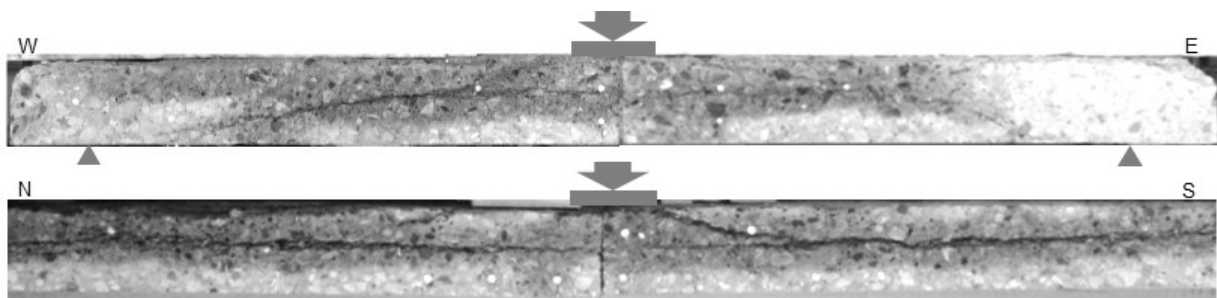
供試体 CF の切断面 (上：橋軸直角 下：橋軸方向)
